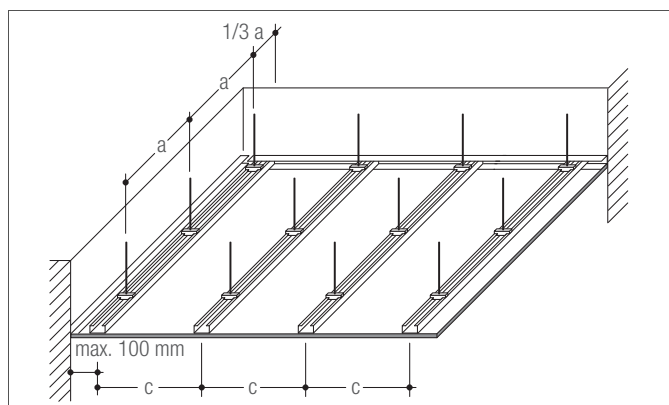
Непосредственное крепление несущего каркаса к перекрытию на шпильках. Соединение со стеной см. Рис. 5-9
